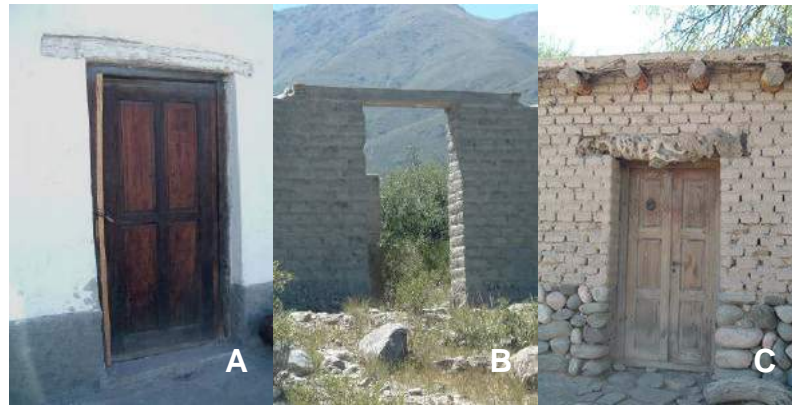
Distintos casos registrados: A- muro adobe-dintel madera (sección rect. doble); B- muro adobe con ceniza-dintel hormigón armado; C- muro adobe-dintel madera (rollizo tallado)
